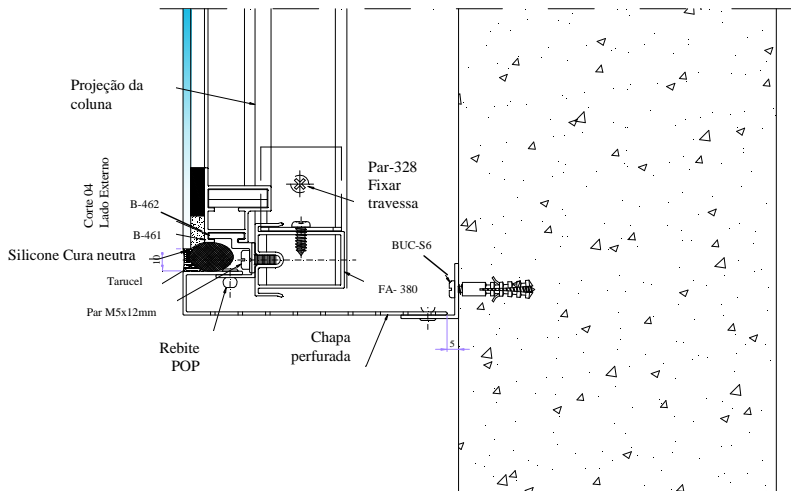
Corte 04: Corte vertical com detalhes do acabamento inferior da câmara de ar. Cotas em mm.
